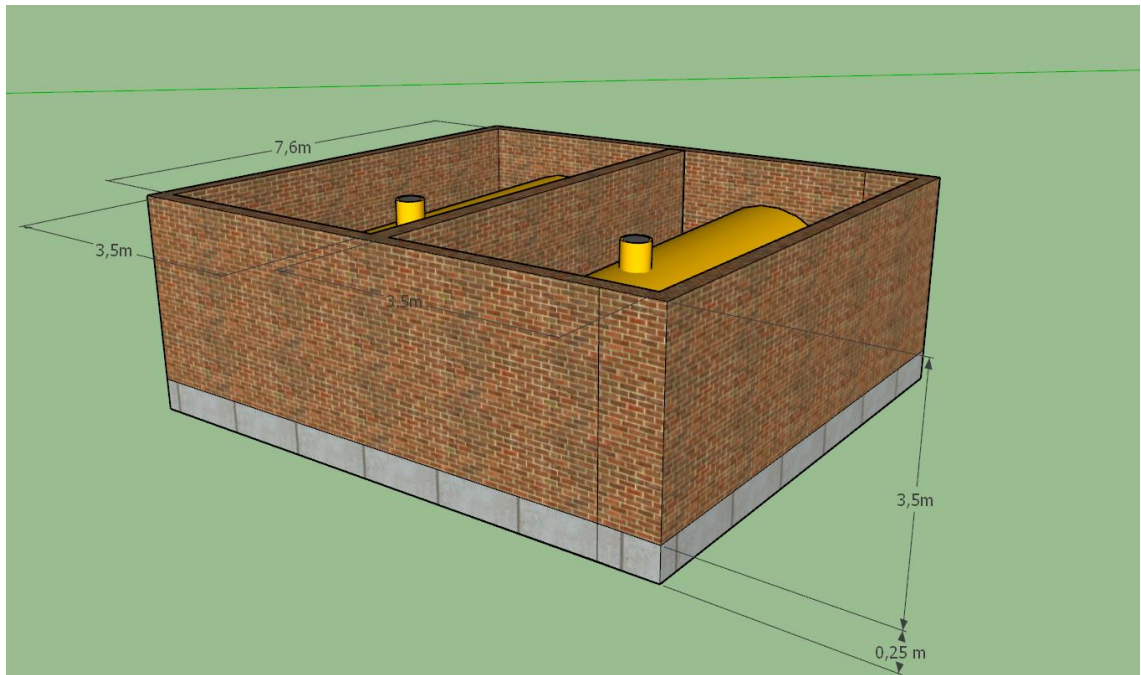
Cubeto de seguridad y losa de hormigón armado. Pr.: SketchUp. Realización propia
